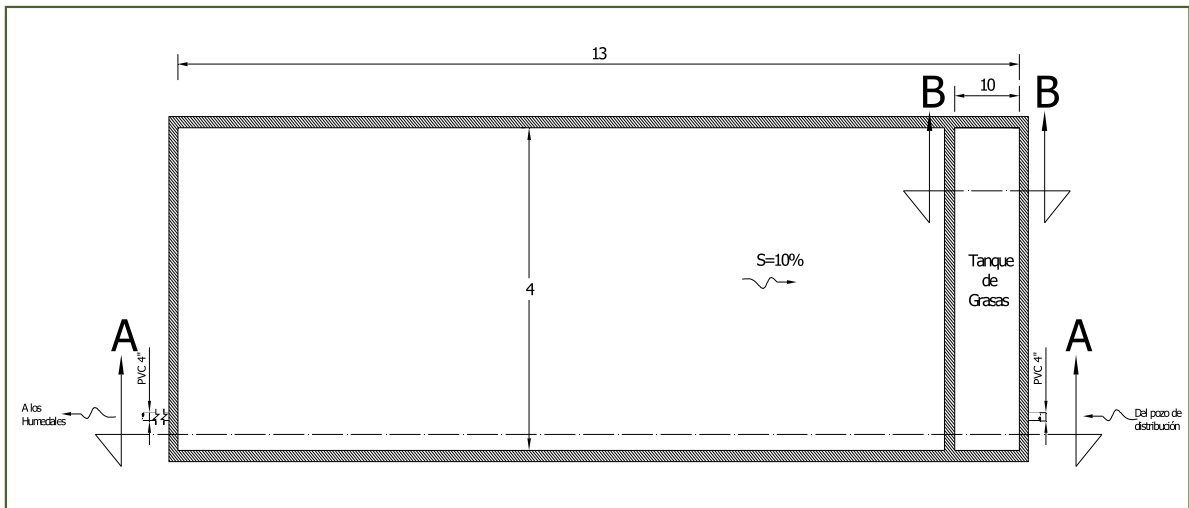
Vista en planta de una de las cámaras de sedimentación (unidades en metros)
